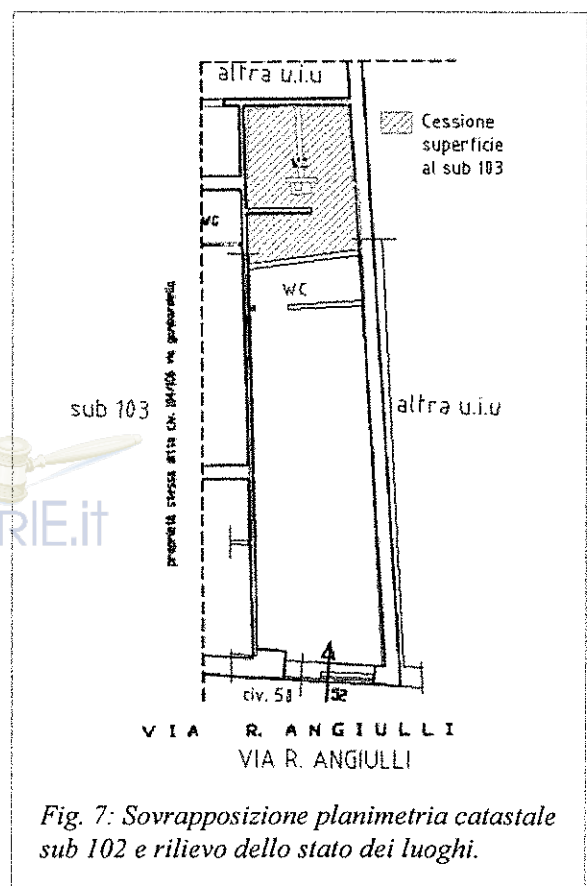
Sovrapposizione planimetria catastale sub 102 e rilievo dello stato dei luoghi.
